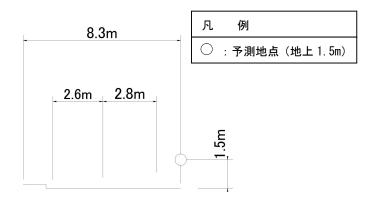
(1)予測断面図(A.村道 12 号線沿道(宮田村 5284-3 地先))
